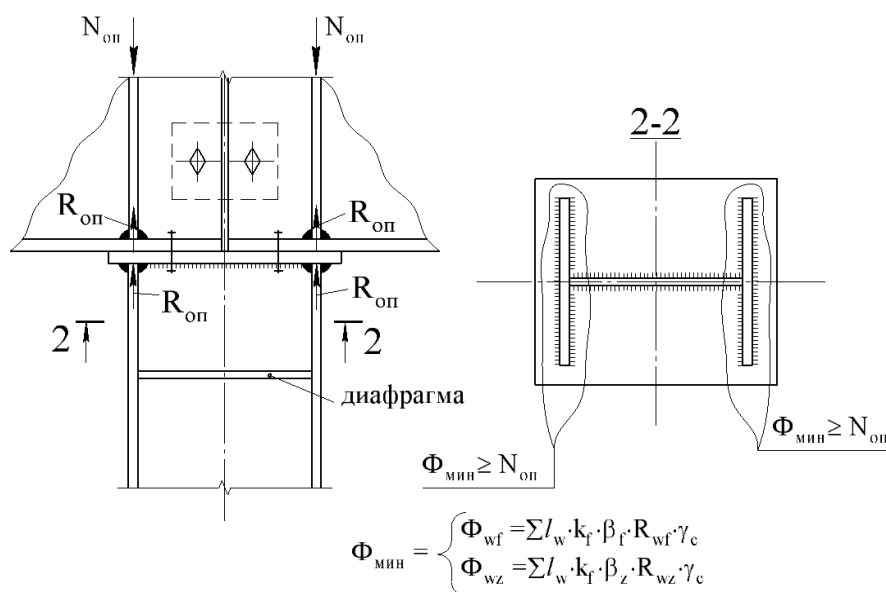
Шарнирное опирание на оголовки колонны балок с внутренними опорными ребрами сверху
